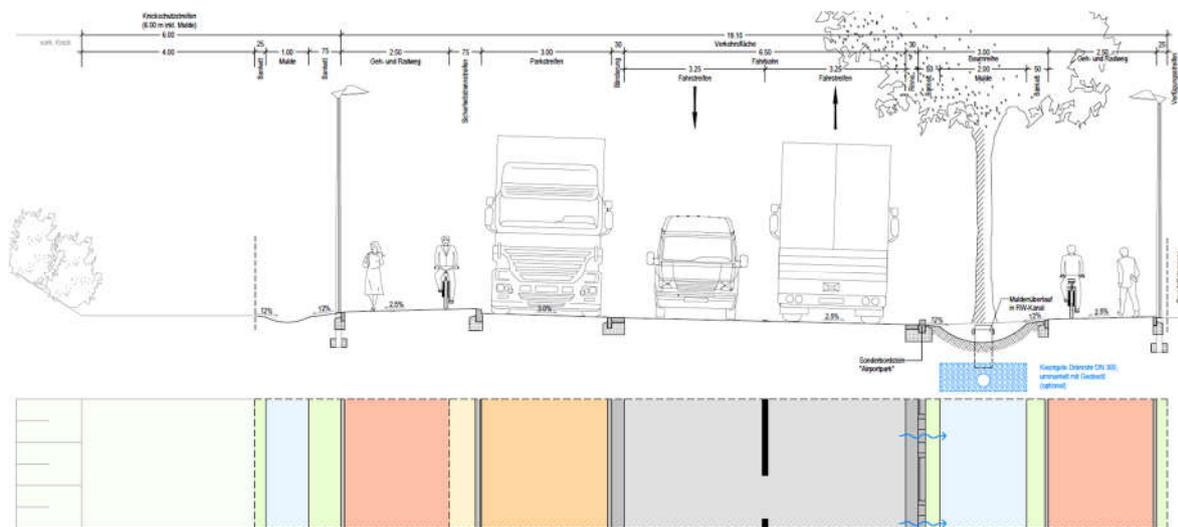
Regelquerschnitt Planstraße A; Planungsbüro Hahm Januar 2022
